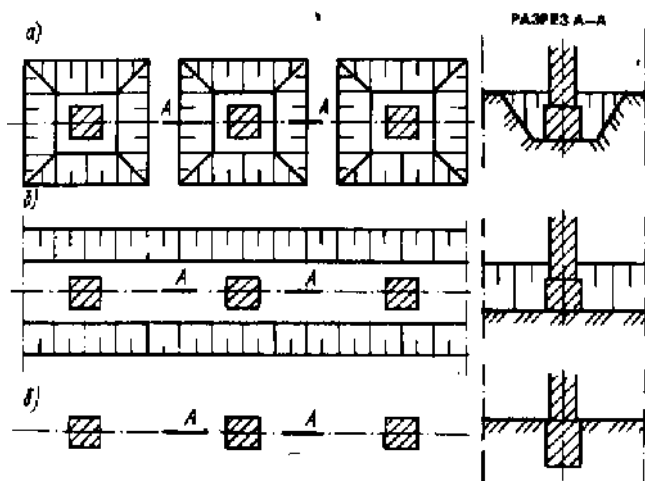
Варианты сооружения отдельно стоящих фундаментов:
